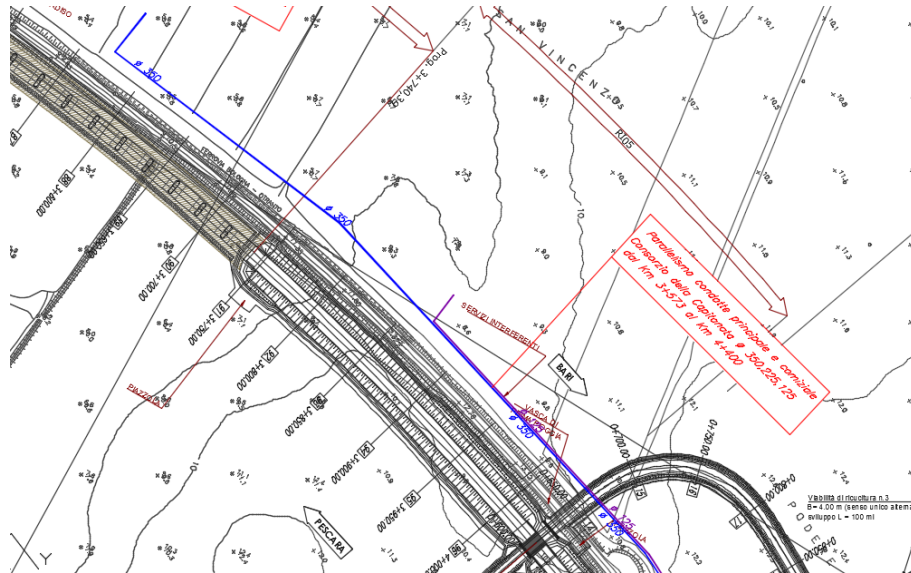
Stralcio planimetrico con individuazione dell'interferenza da km 3+570 a km 4+400 (φ350-125-250).
